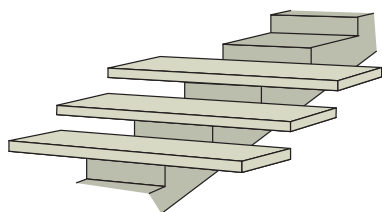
Fribärande steg på centralt placerad betongbalk.
